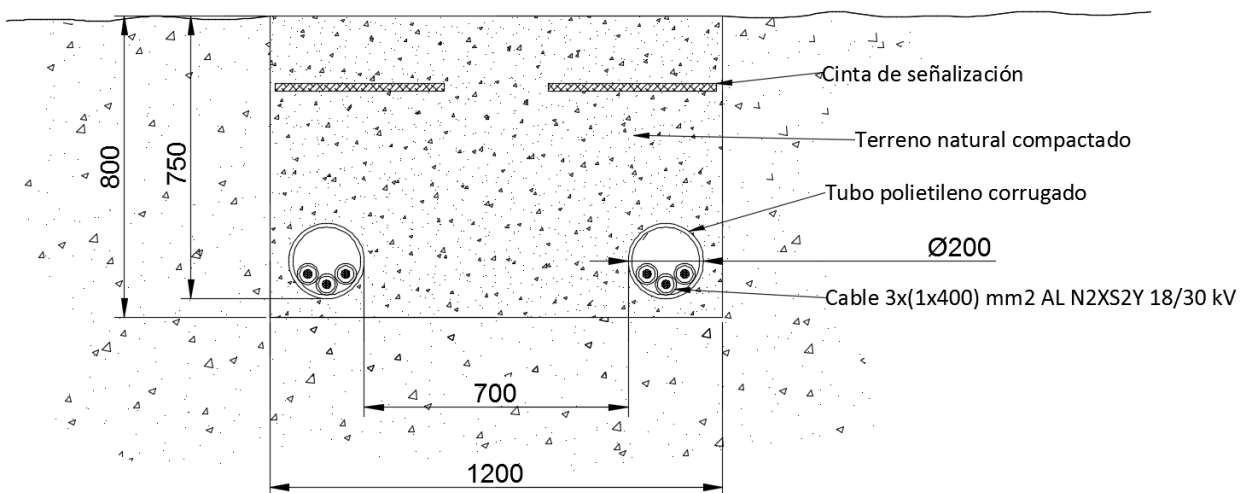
Doc. I. Memoria - Detalle zanja MT. Paso bajo tubo.
